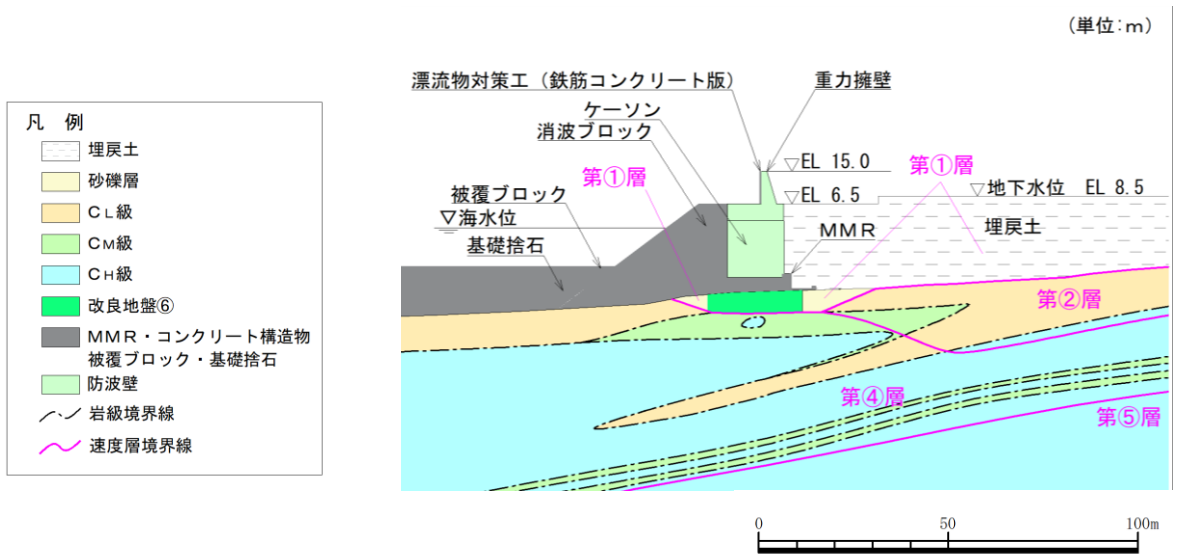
(2) 地質断面図 (防波壁 (波返重力擁壁) ②-②断面)
